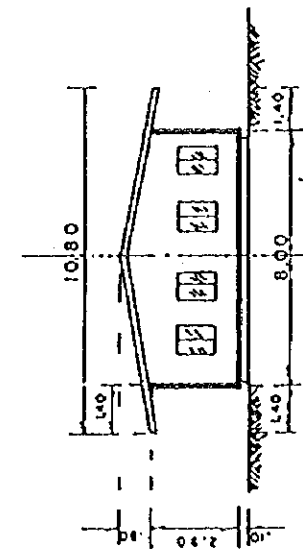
OFICINA DE CENTRO DE APOYO RURAL
